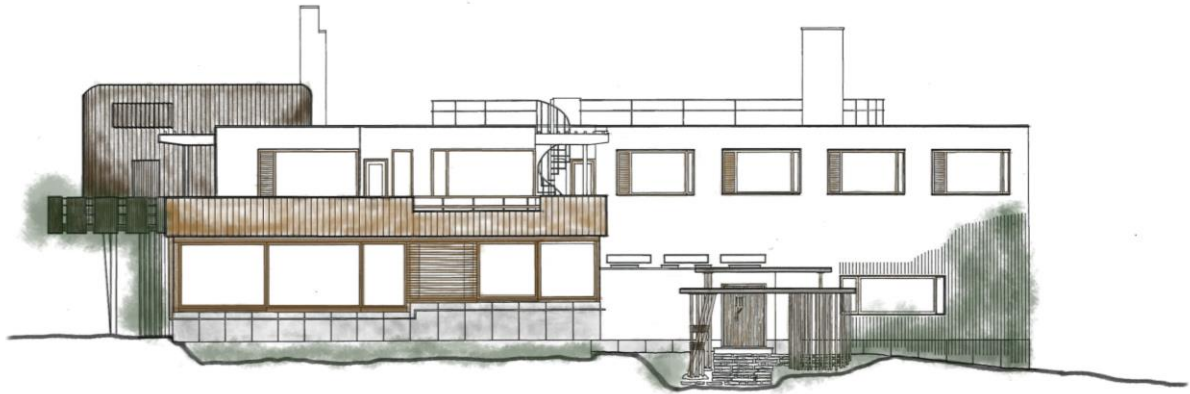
Alzado lonxitudinal Vila Mairea. Versión construída_Elaboración propia
